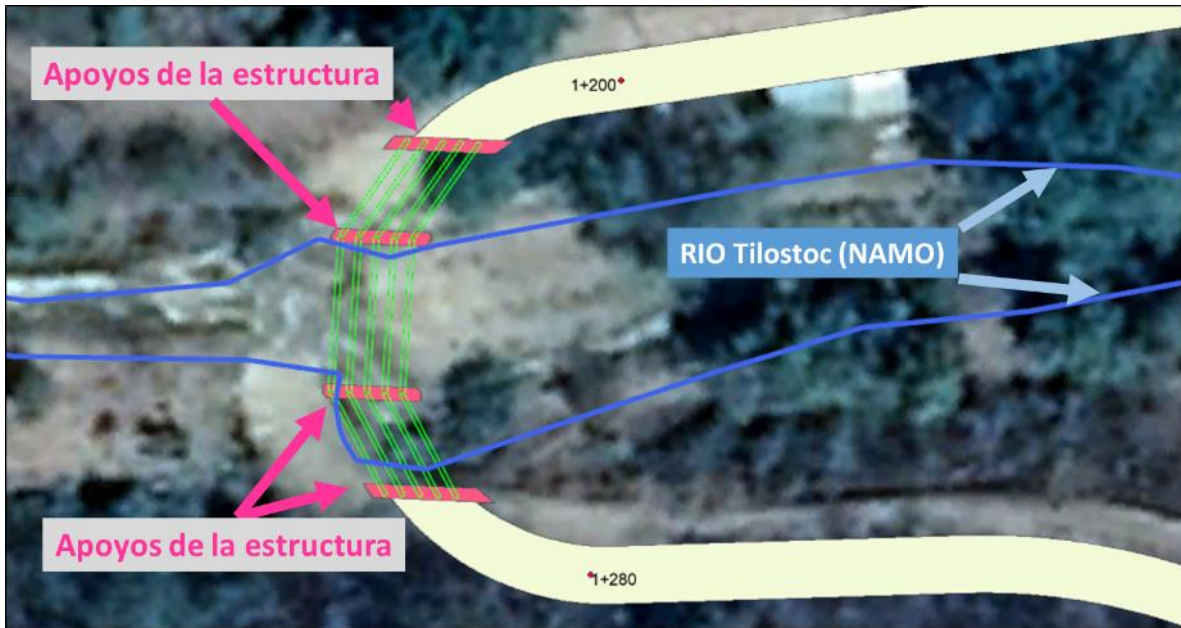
Diseño de las traves proyectadas que darán soporte a la estructura
